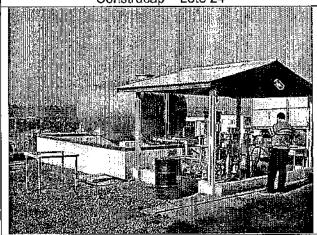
Jazida Morro Agudo – Const. Ivai –lote 23
